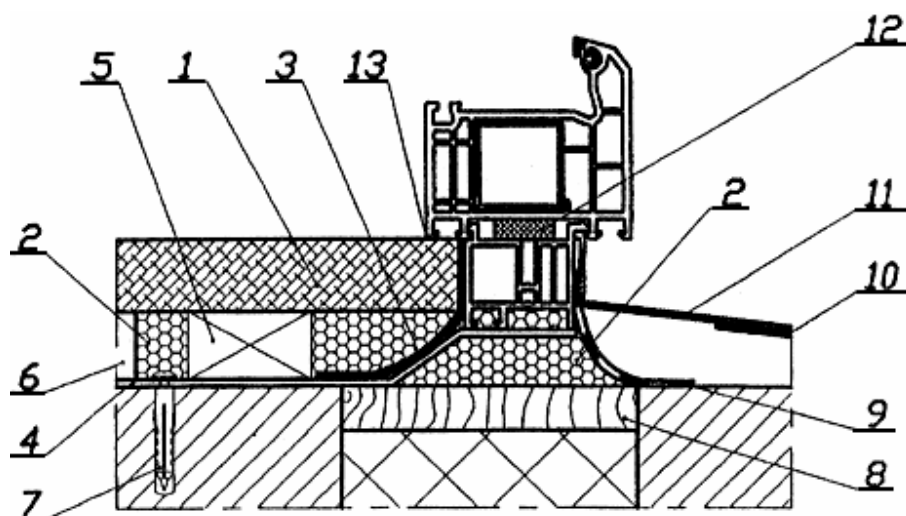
Узел нижнего примыкания оконного блока, подоконника и слива к проему слоистой стены с эффективной теплоизоляцией:
